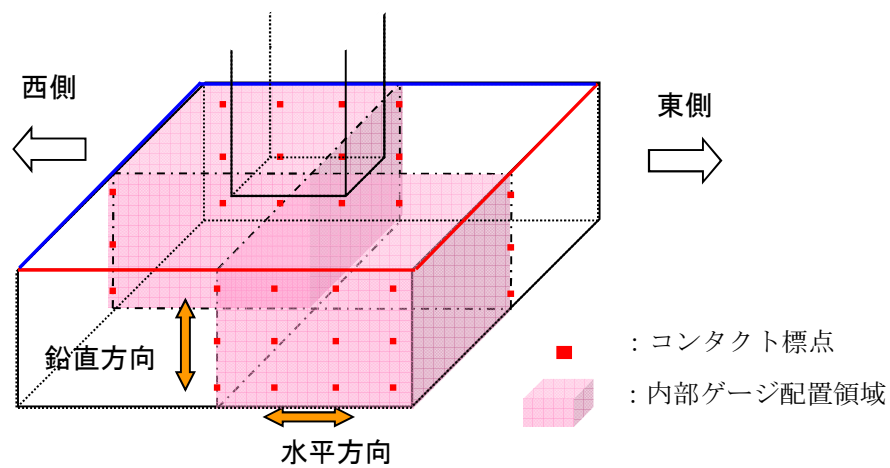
コンタクトゲージによるコンクリート表面ひずみの計測概要
